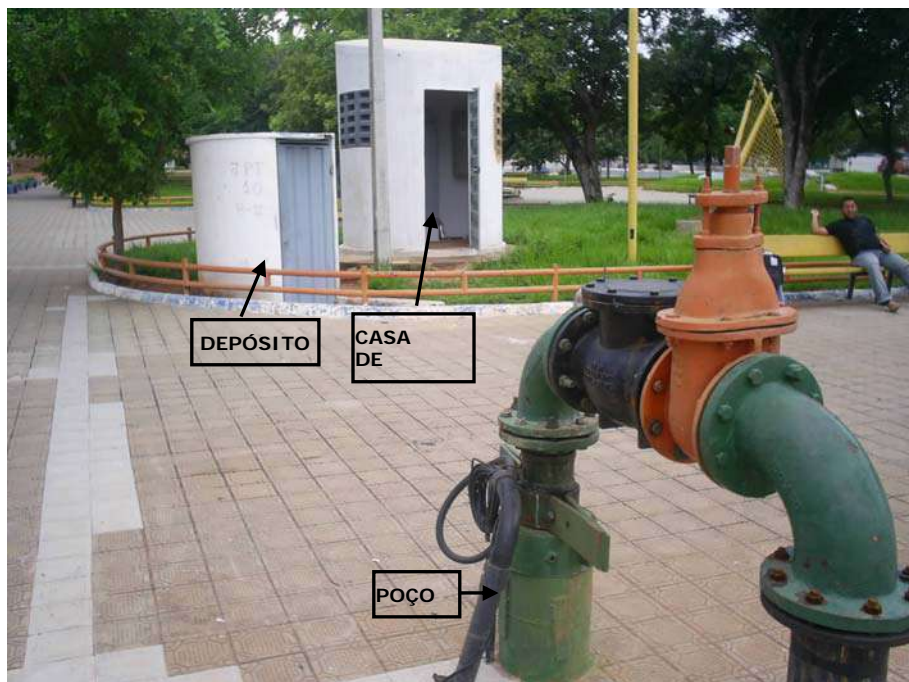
Detalhes da Área do Poço PT 10, sem Isolamento e Proteção
